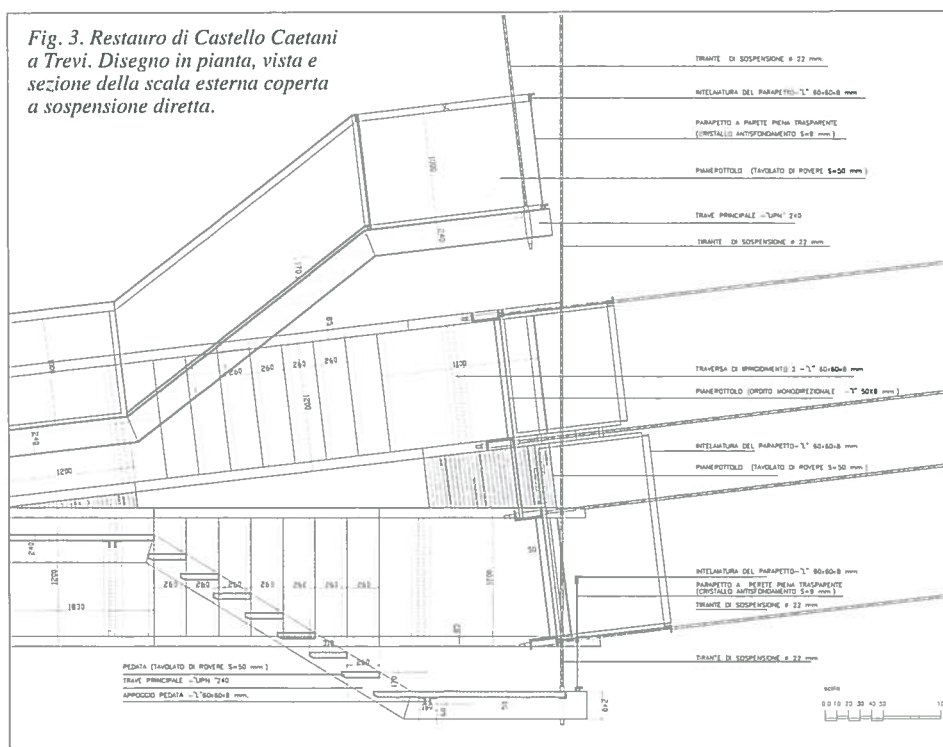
Restauro di Castello Caetani a Trevi. Disegno in pianta, vista e sezione della scala esterna coperta a sospensione diretta.
